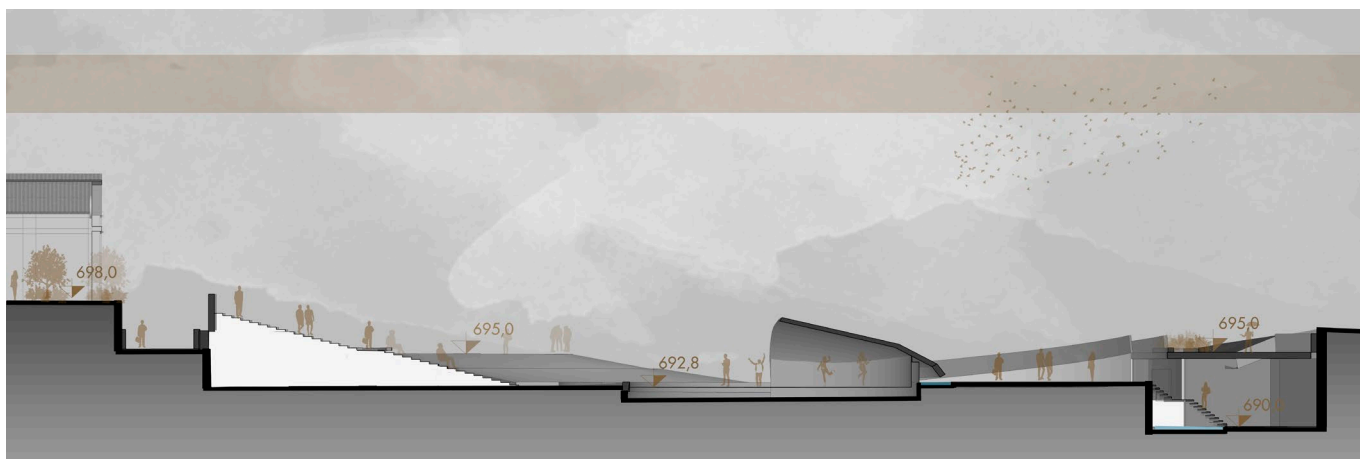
Corte BB / Fonte: Aatoria do grupo.
